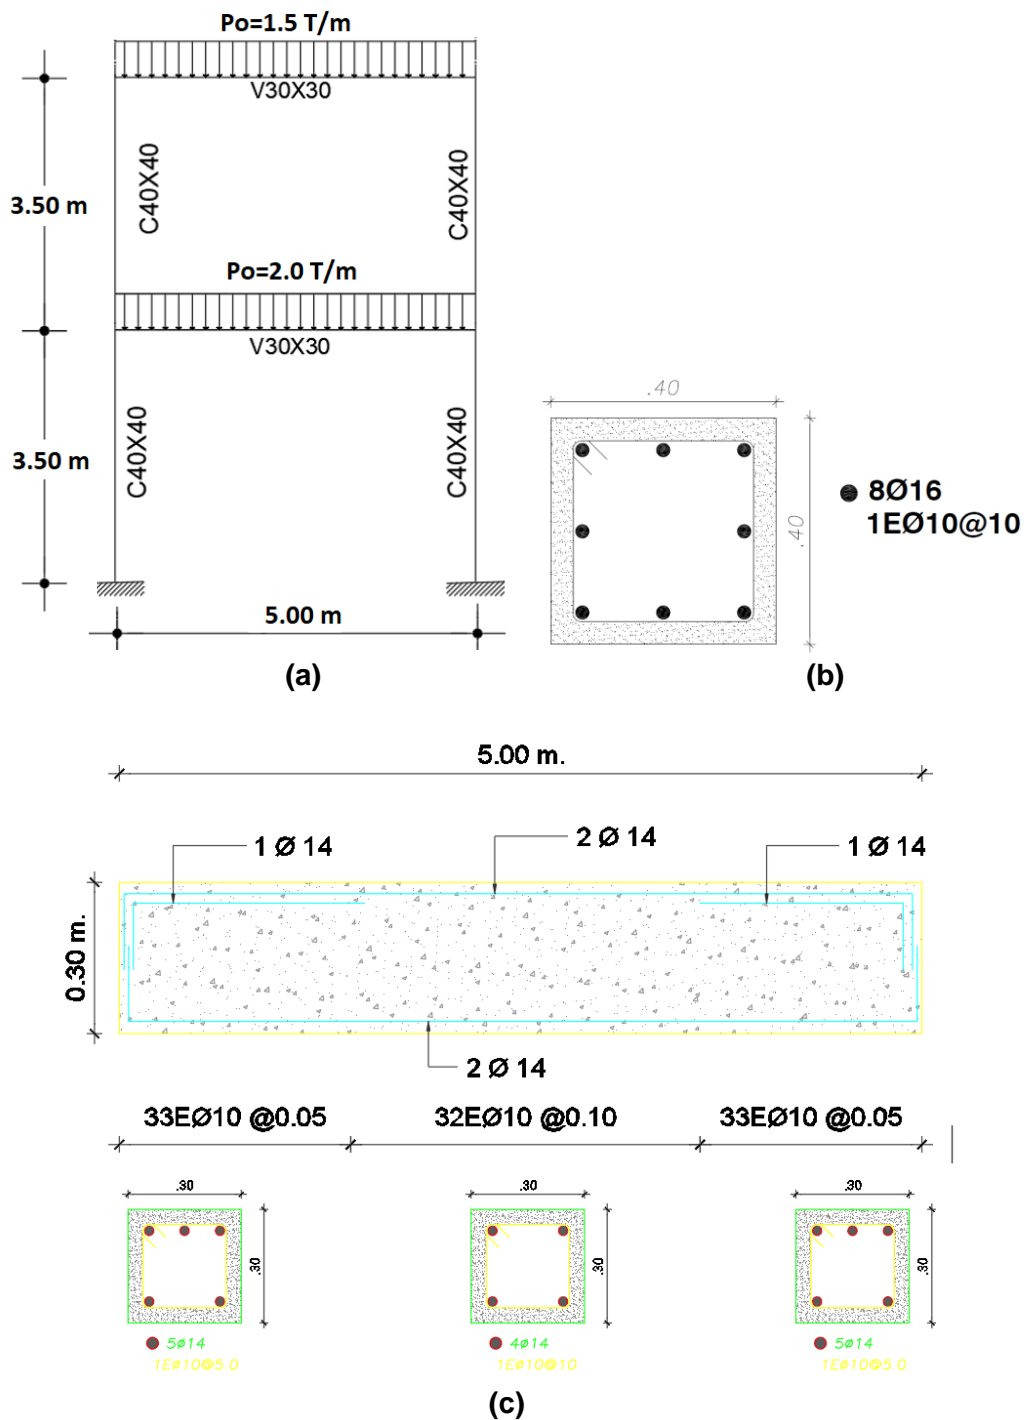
a) Geometría del Pórtico de hormigón armado de dos pisos; b) Armadura longitudinal y transversal de una columna; c) Armado de las vigas de primer piso igual a segundo piso, en nudo inicial, centro de luz y nudo final.
